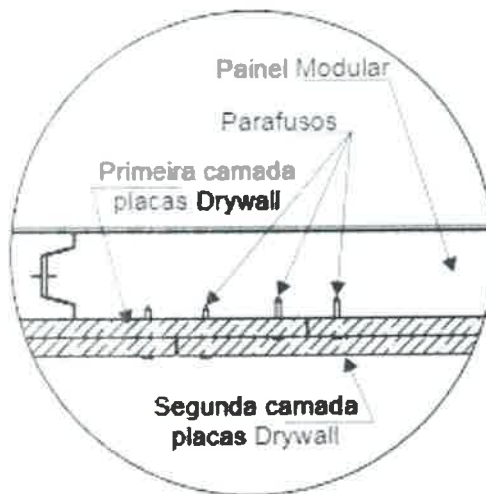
Detalhe da fixação do revestimento duplo de Drywall
